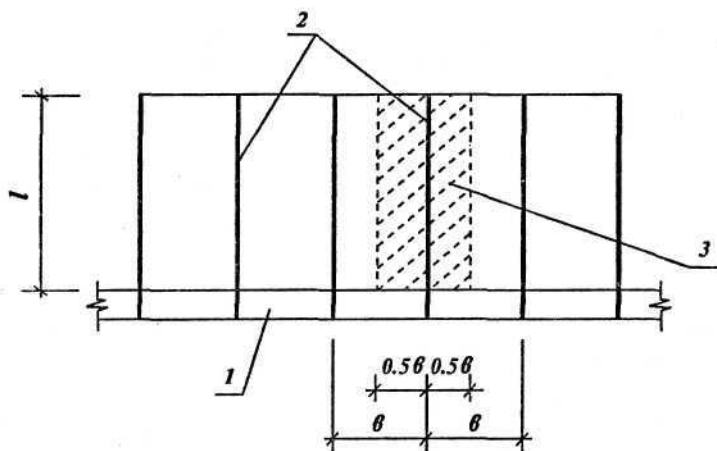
Схема сбора нагрузки на несущую консольную балку:
